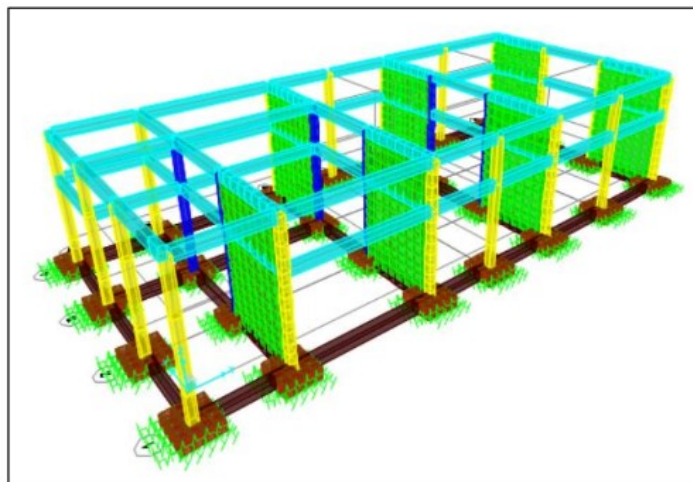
Labels de elemento tipo Frame, cobertura metálica.
